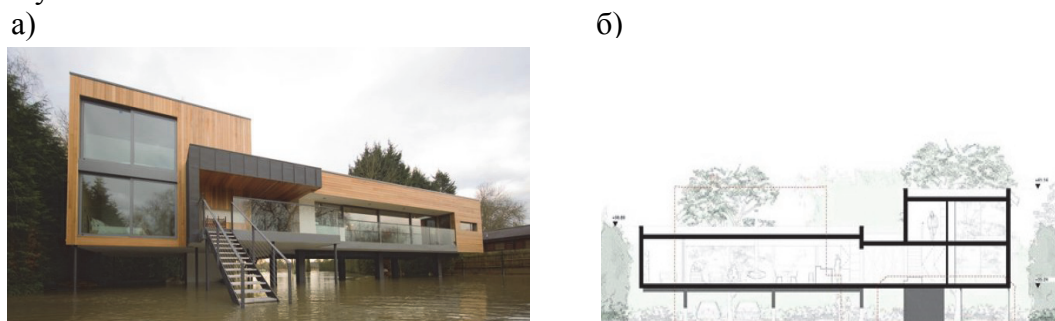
Пример сооружения на свайном фундаменте «Задний Дом» (Hind House):
